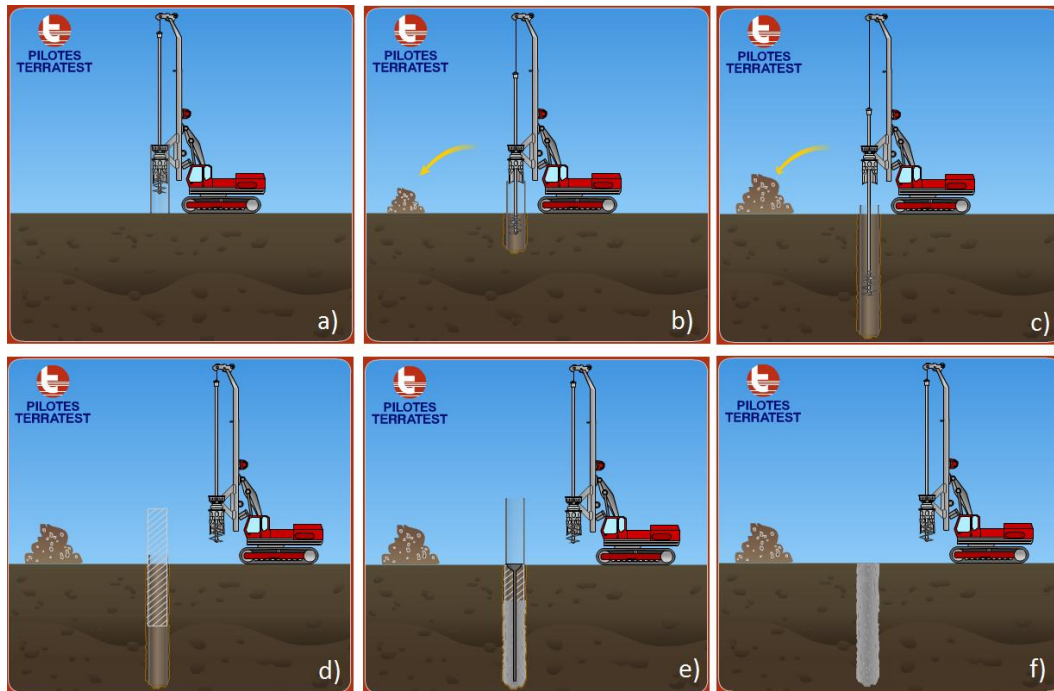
Proceso constructivo de un pilote en seco: a) Perforación del terreno, b) Extracción de material, c) Perforación a profundidad deseada, d) Colocación de armadura, e) Vaciado de concreto, f) Retiro de equipos (Pilotes Terratest Perú, 2015)
